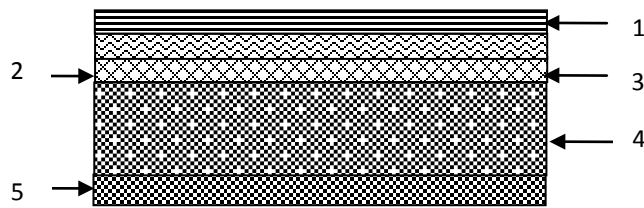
Coupe transversale dans le plancher à dalle pleine.
